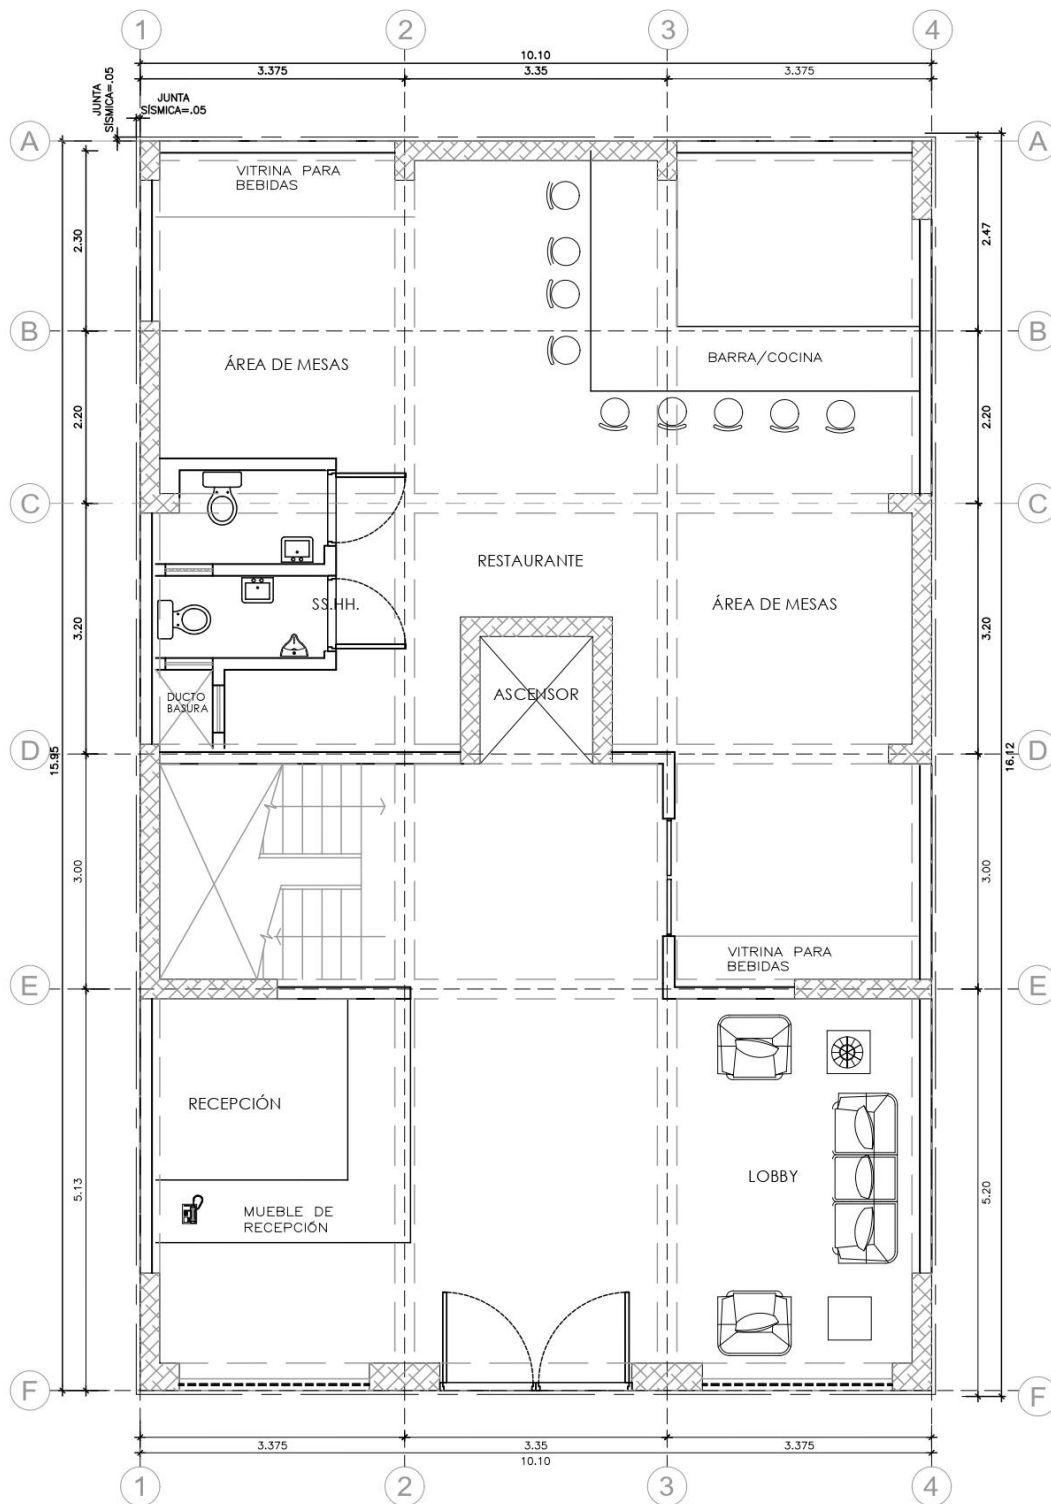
Planta arquitectónica de primer piso. Fuente: Propia.
